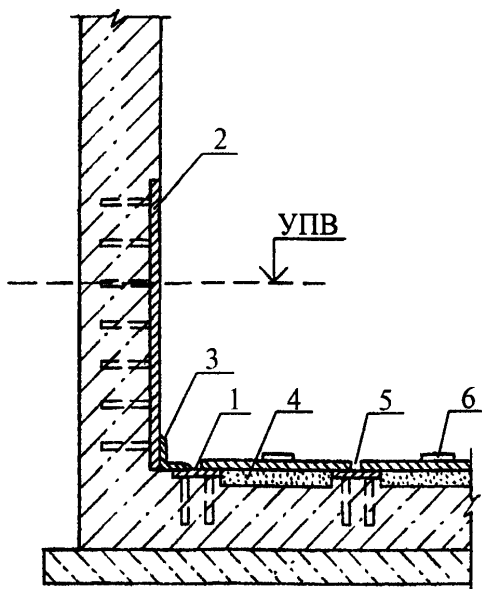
Металлическая гидроизоляция тоннеля при наличии подземных вод
